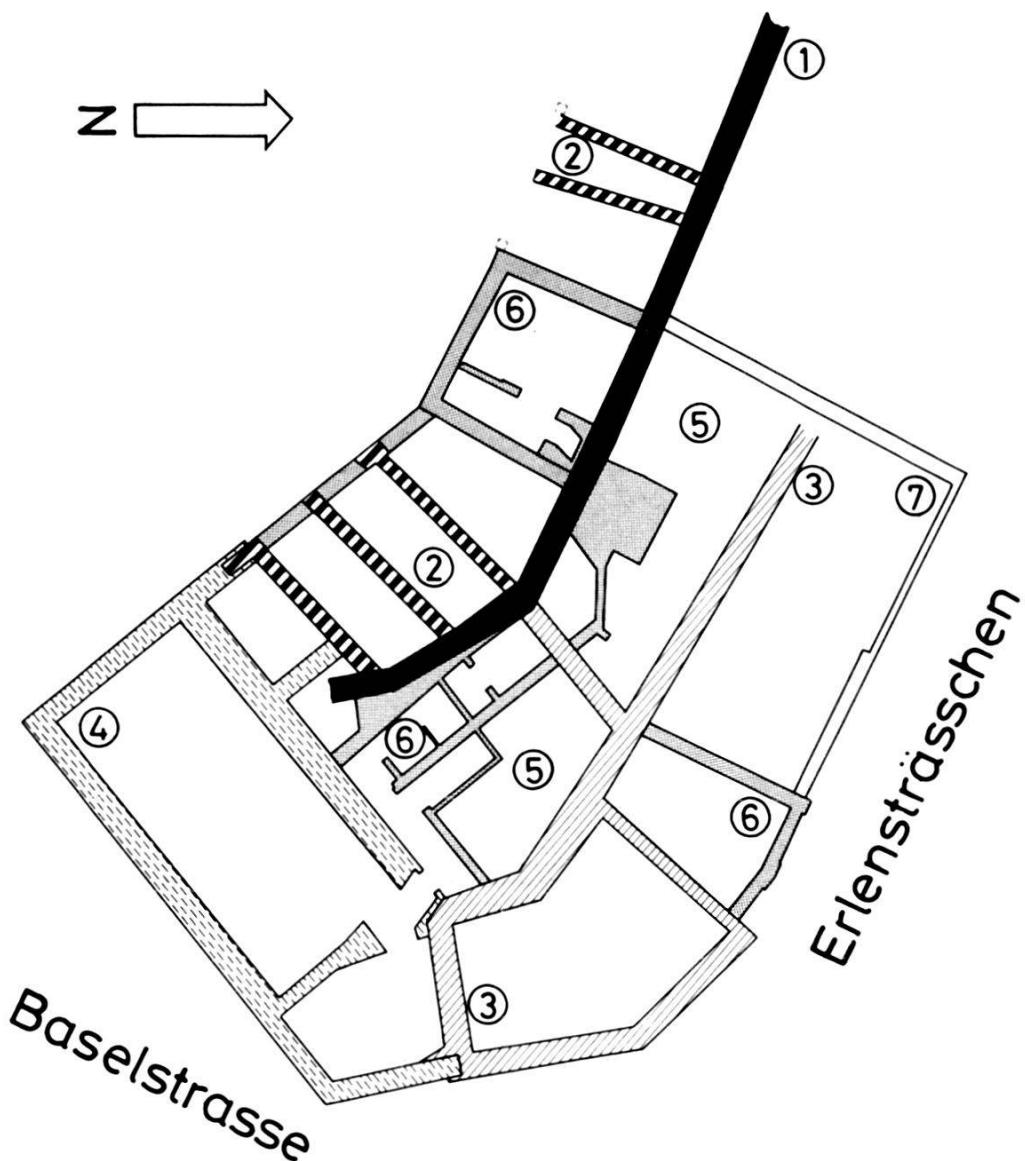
Riehen-Dorfkirche. Detailplan Gemeindekanzlei. – Zeichnung: E. Albrecht nach Plangrundlagen des Büros W. Stöckli, Moudon. Massstab 1:400.
